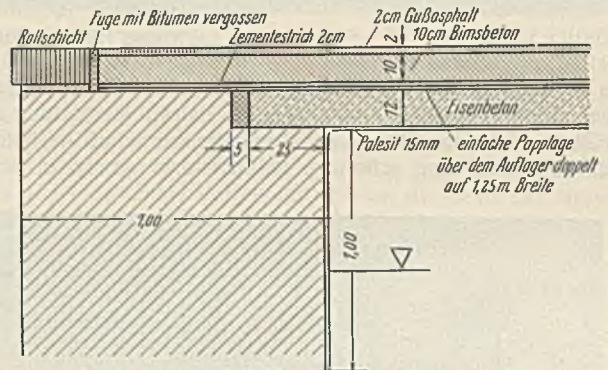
Schnitt durch die Deckenkonstruktion des Hauptfaulbehälters.
